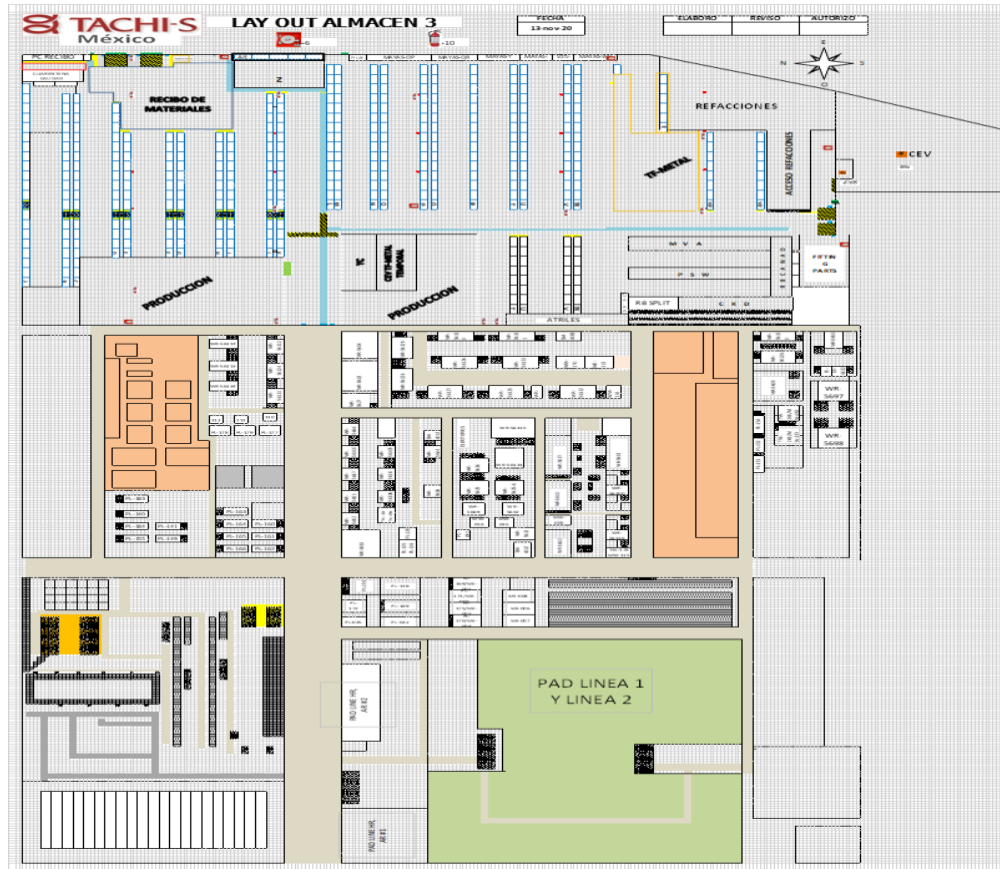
Lay Out Planta completa de Tachi-s México PIVA
